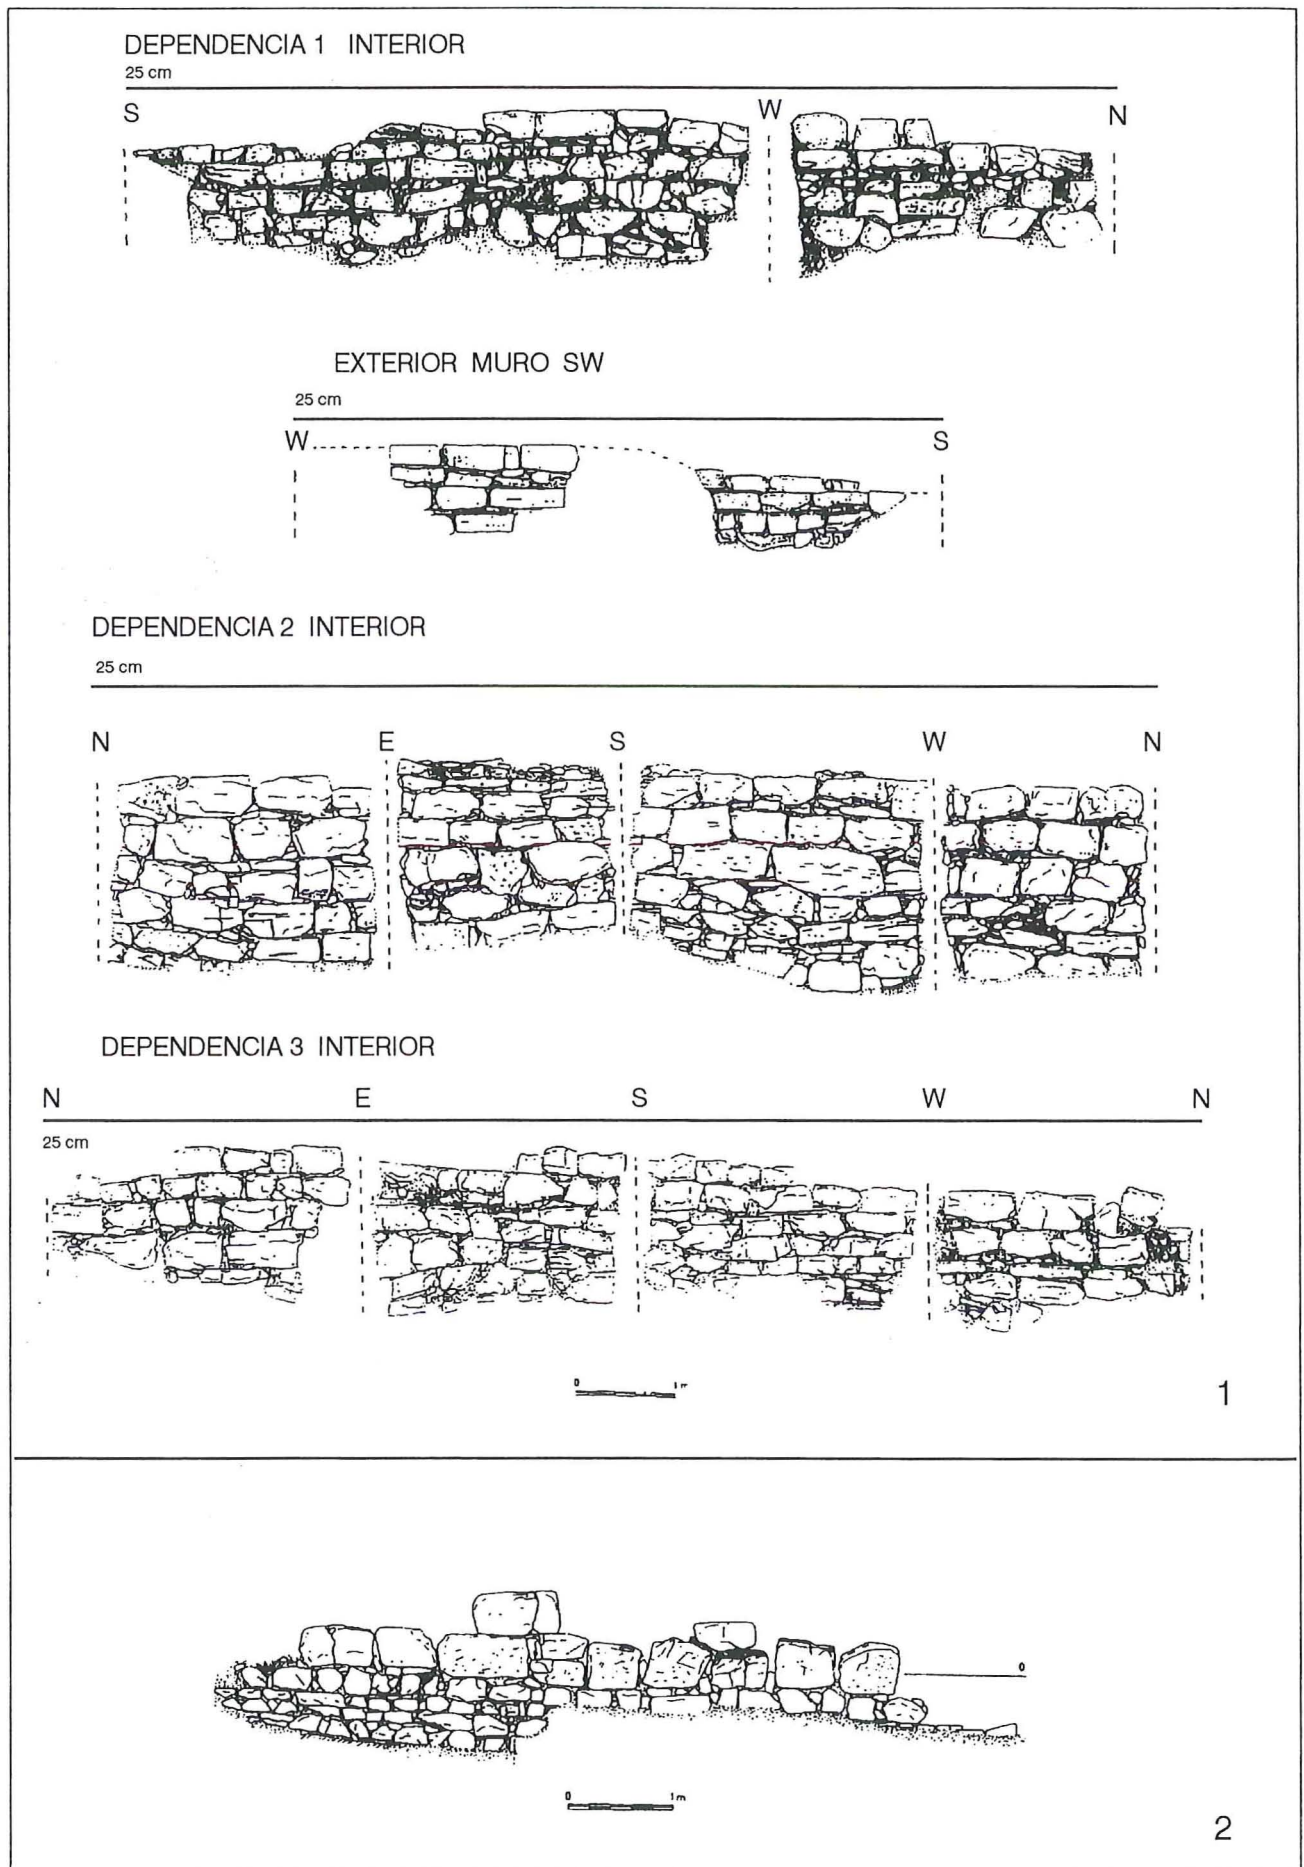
1. Alzados del “Edificio A”. 2. Alzado de la “Construcción M.1”.
